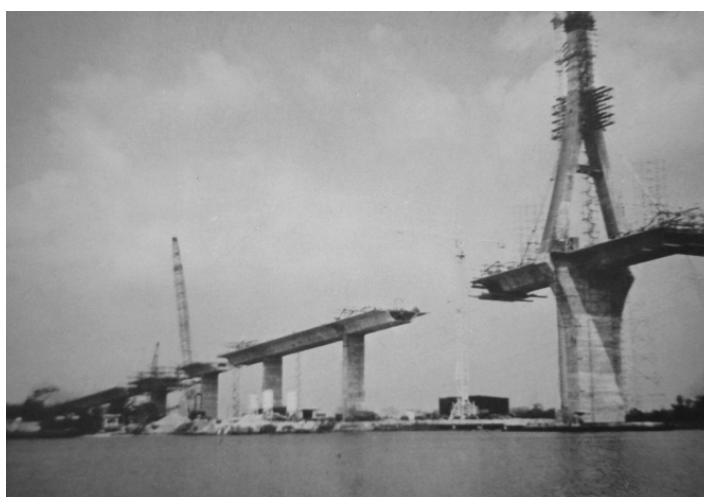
Vista del puente Antonio Dovalí Jaime durante su construcción.
